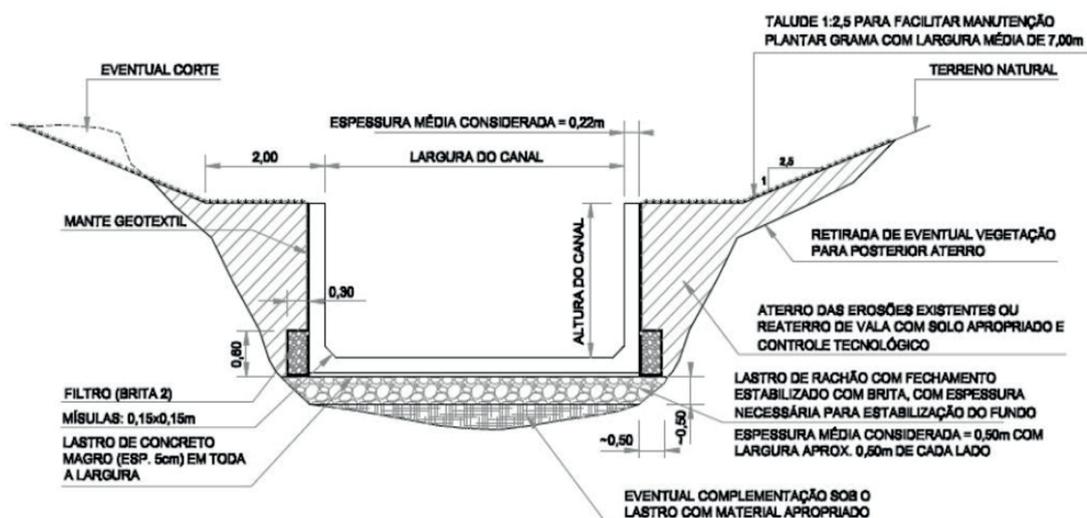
Corte típico dos canais em aduelas de concreto pré-moldado.
